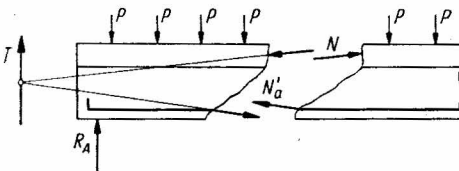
Directions des résultantes  $N$  et  $N'_a$  avant la formation d'une fissure horizontale dans le cas où la poutre est sans armature transversale
